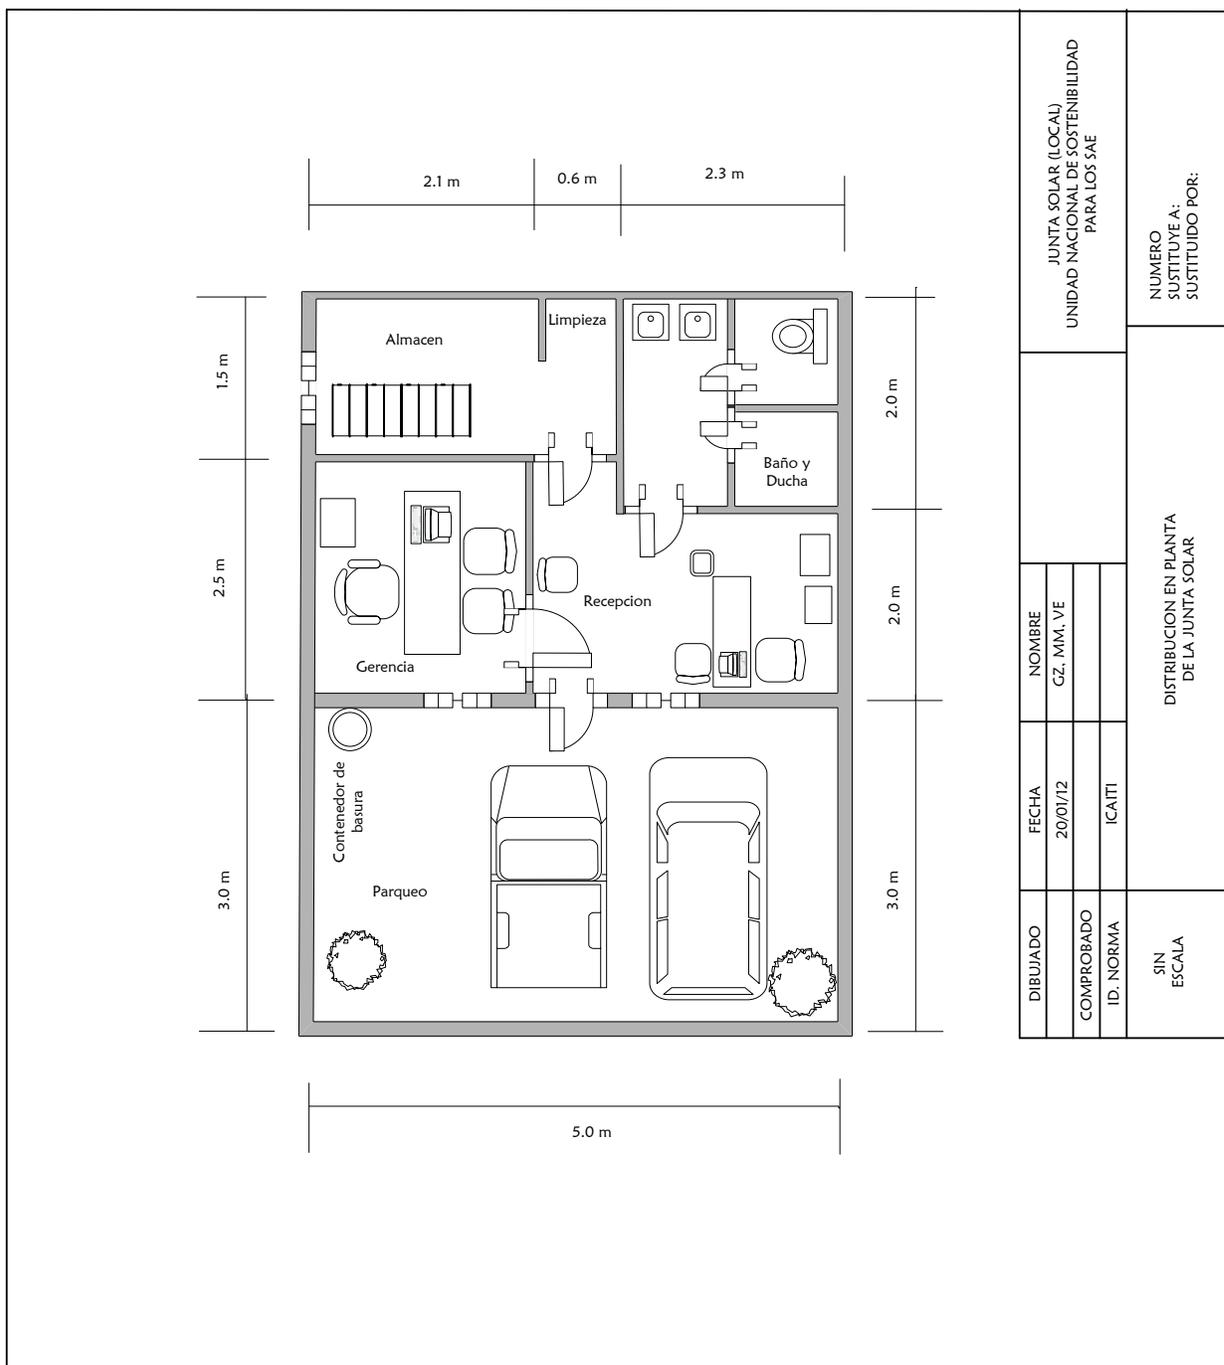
Distribucionanta de la Junta Solar Local – Plano general
